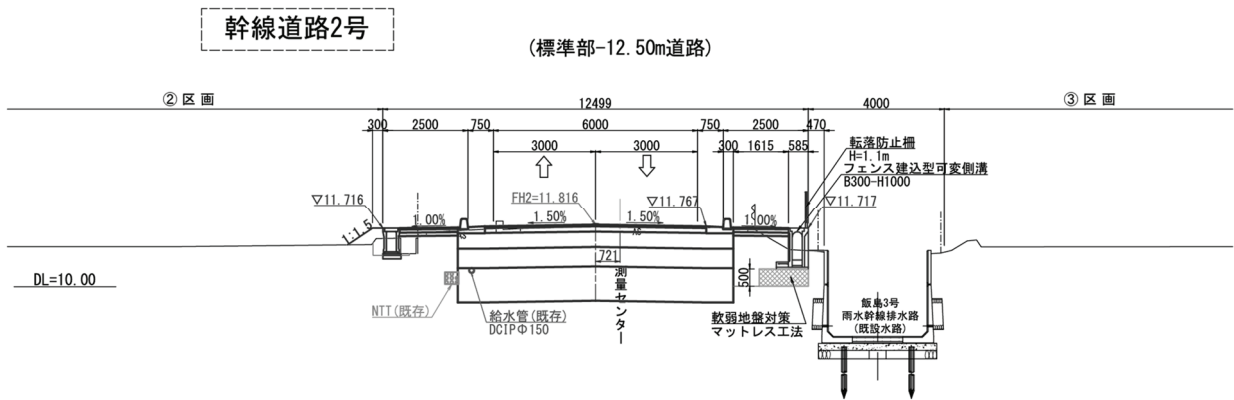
(5) 標準断面図(幹線道路 2 幅員 12.5m)
